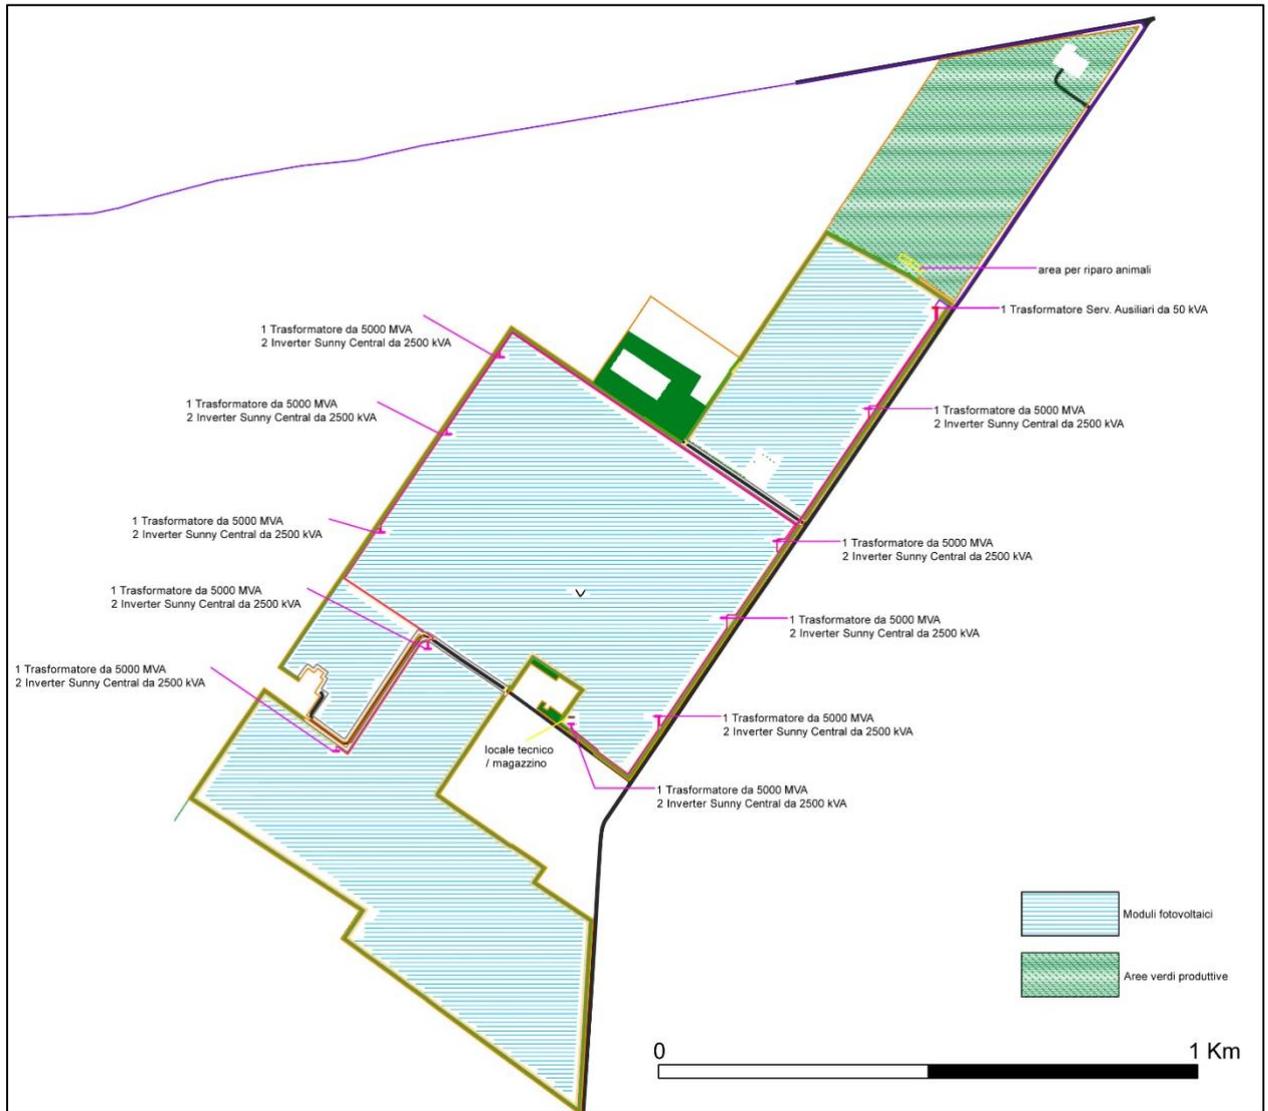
progetto dell'impianto fotovoltaico, estratto da progetto GIS.
